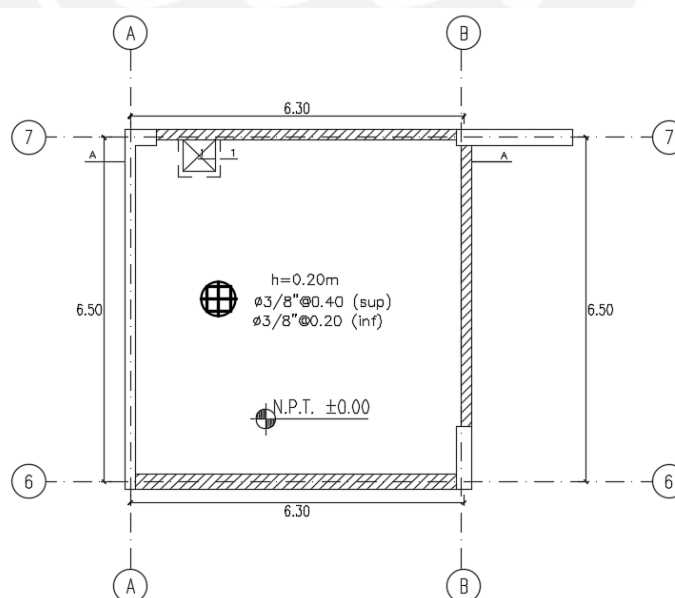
Disposición del acero en la losa de techo de la cisterna.
